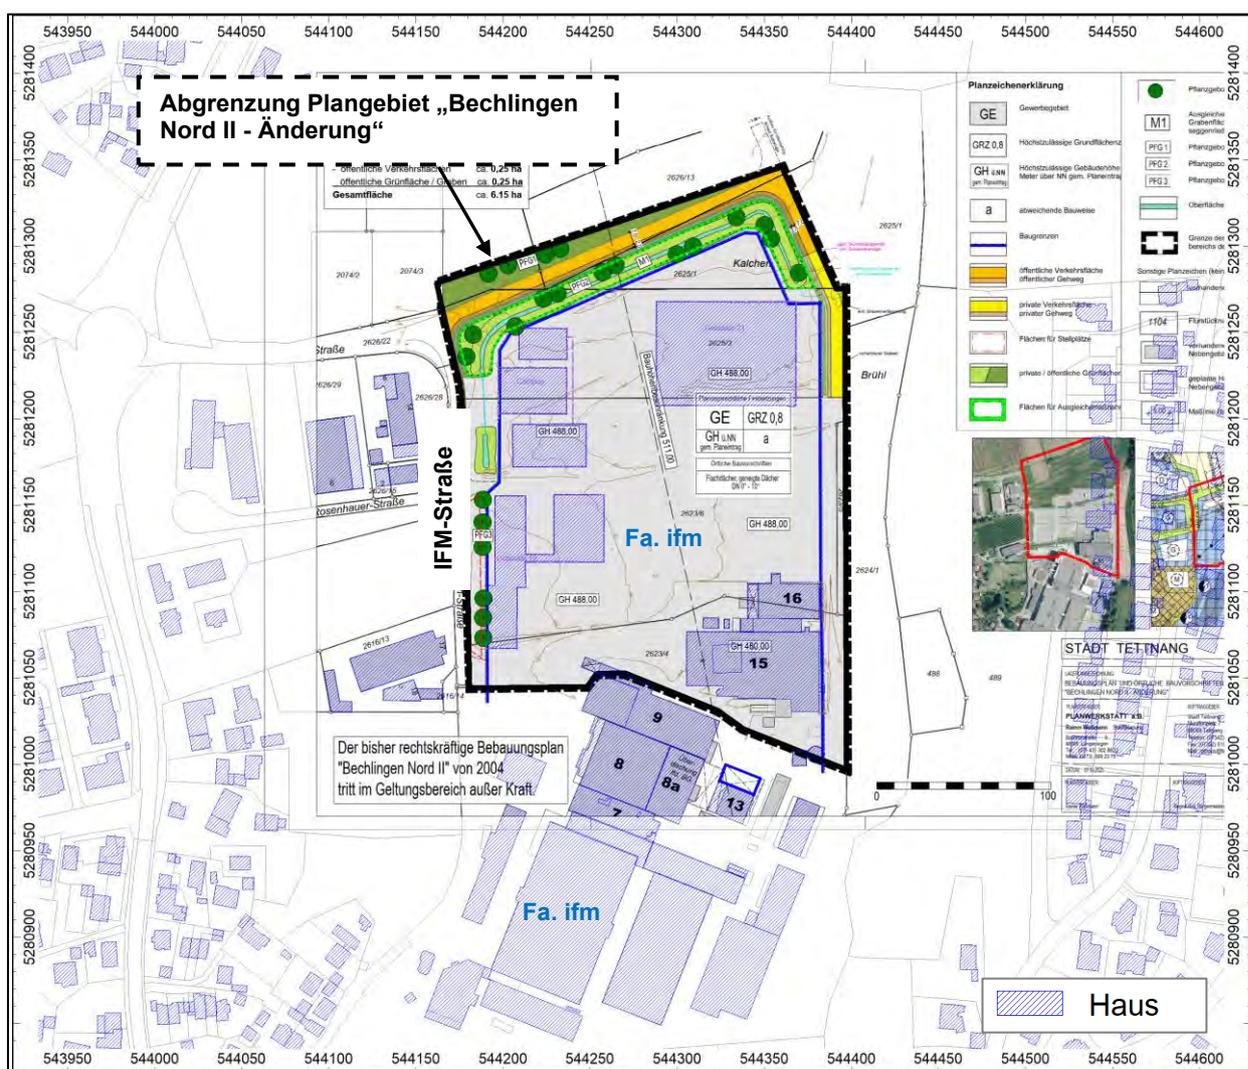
Planzeichnung zum Bebauungsplan „Bechlingen Nord II - Änderung“ gemäß derzeitigem Planungsstand /15/
